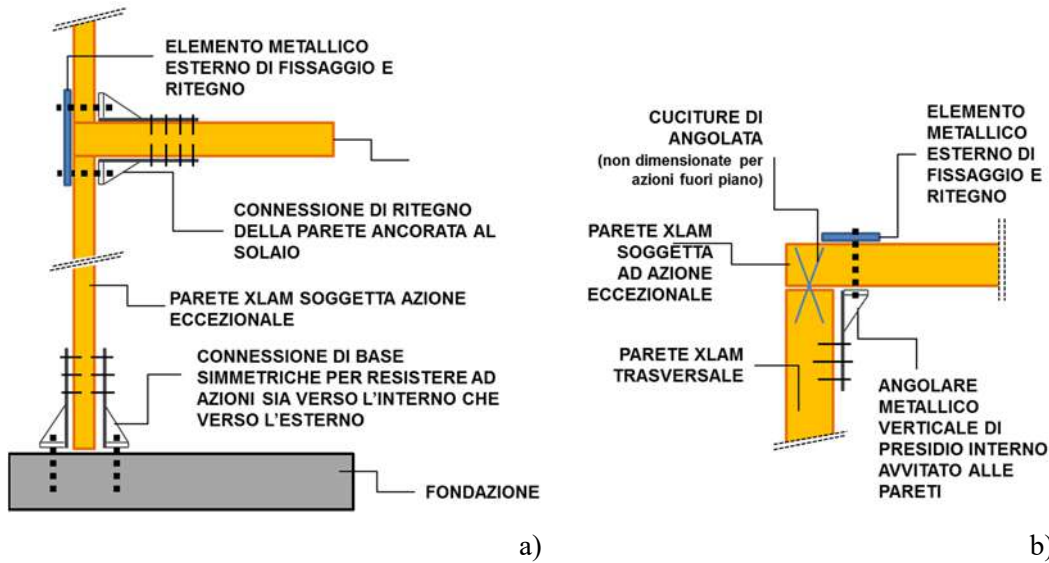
Esempio di connessioni delle pareti resistenti alle azioni fuori piano: a) collegamento alla fondazione e a livello di solaio; b) collegamento con le pareti di spina
